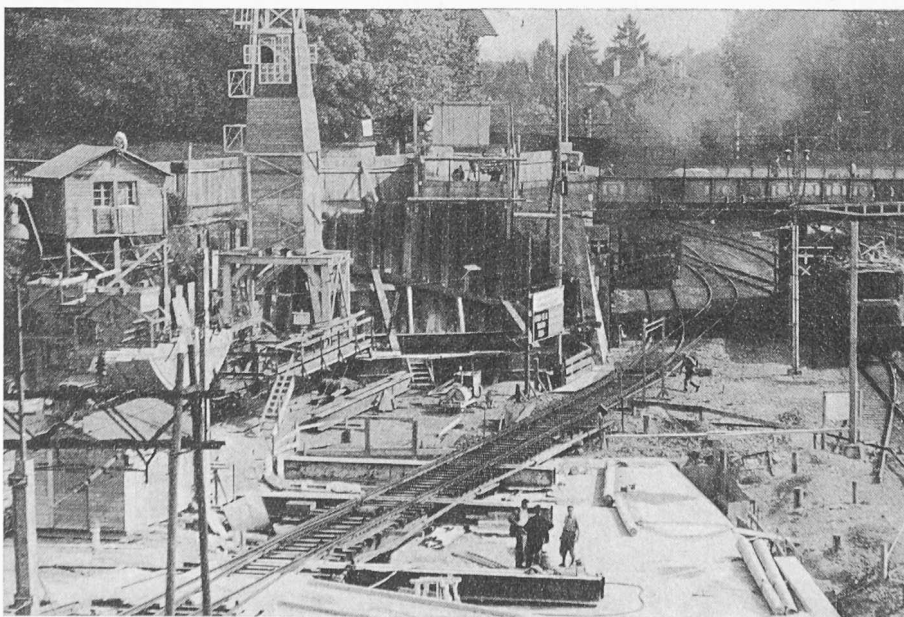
Ansicht der Baustelle beim Westportal. Im Vordergrund die Anschlussstrecke des Tunnels, welche im Tagbau erstellt wird, im Hintergrund der Schacht
